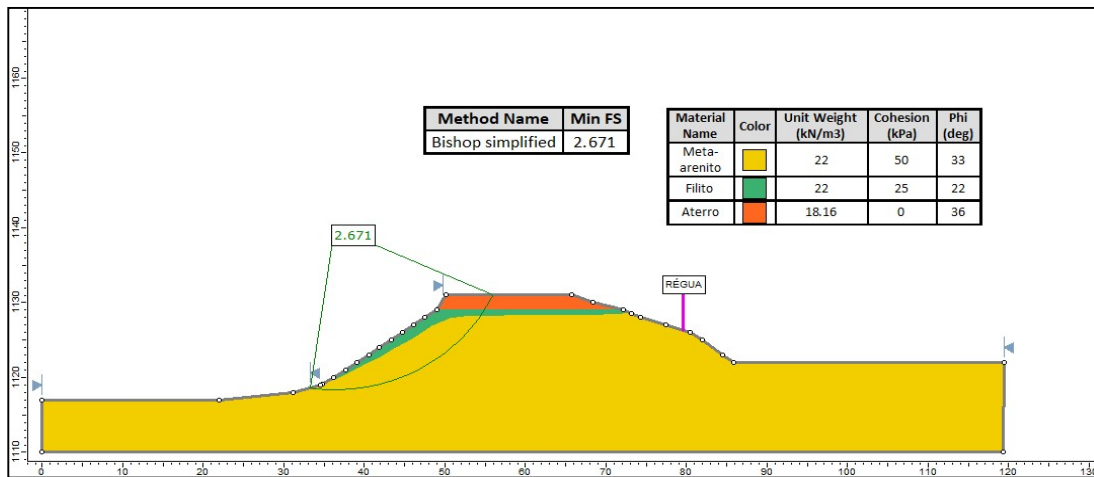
Fase final de construção – Bishop Simplificado - Jusante – Global.
